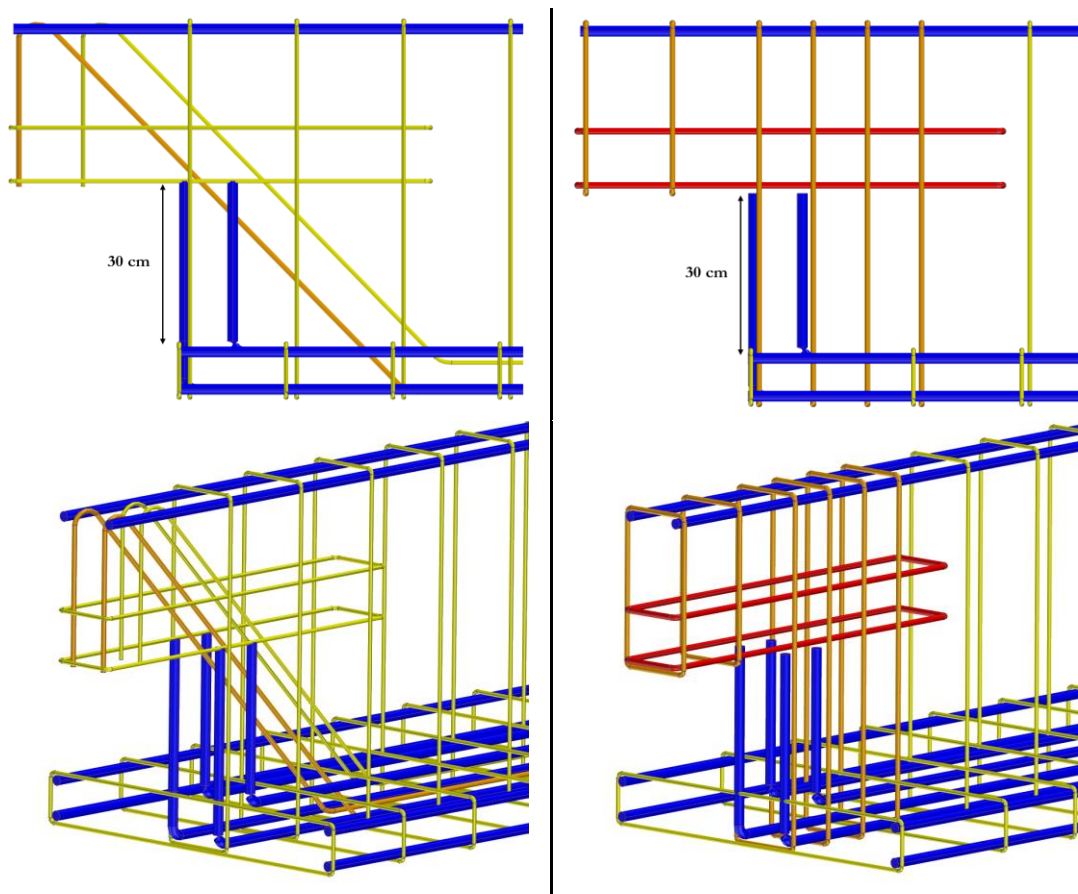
Dettaglio piego armature: trave B (sx) e trave A (dx)
